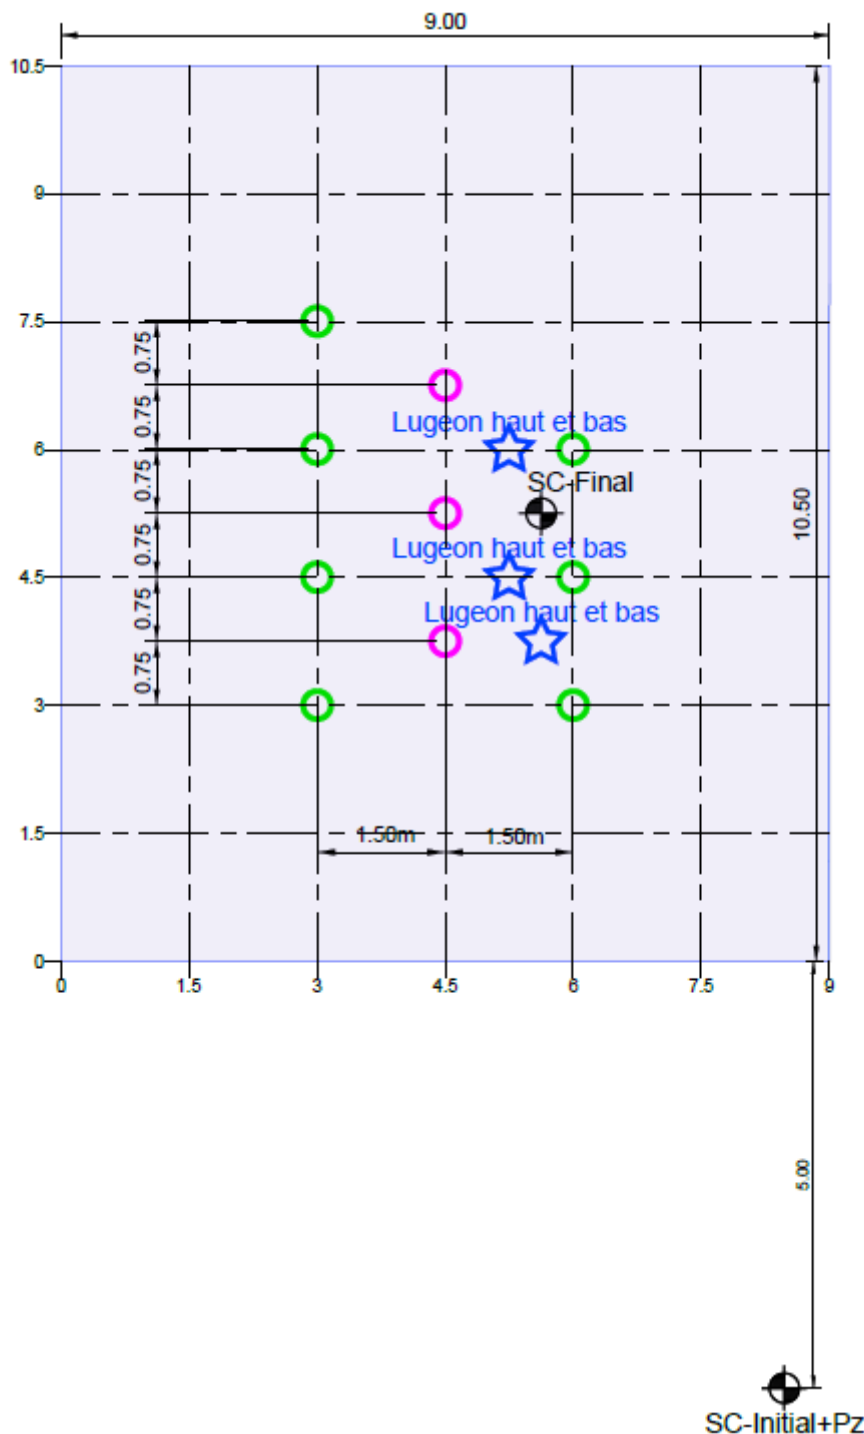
Emprise et maillage de la planche d'essai principale. En vert le maillage primaire et en rose le maillage secondaire
